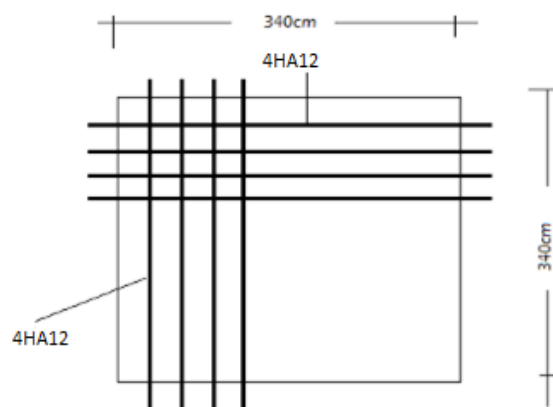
Schéma du ferrailage en travée des dalles. (Nappes inférieures).
